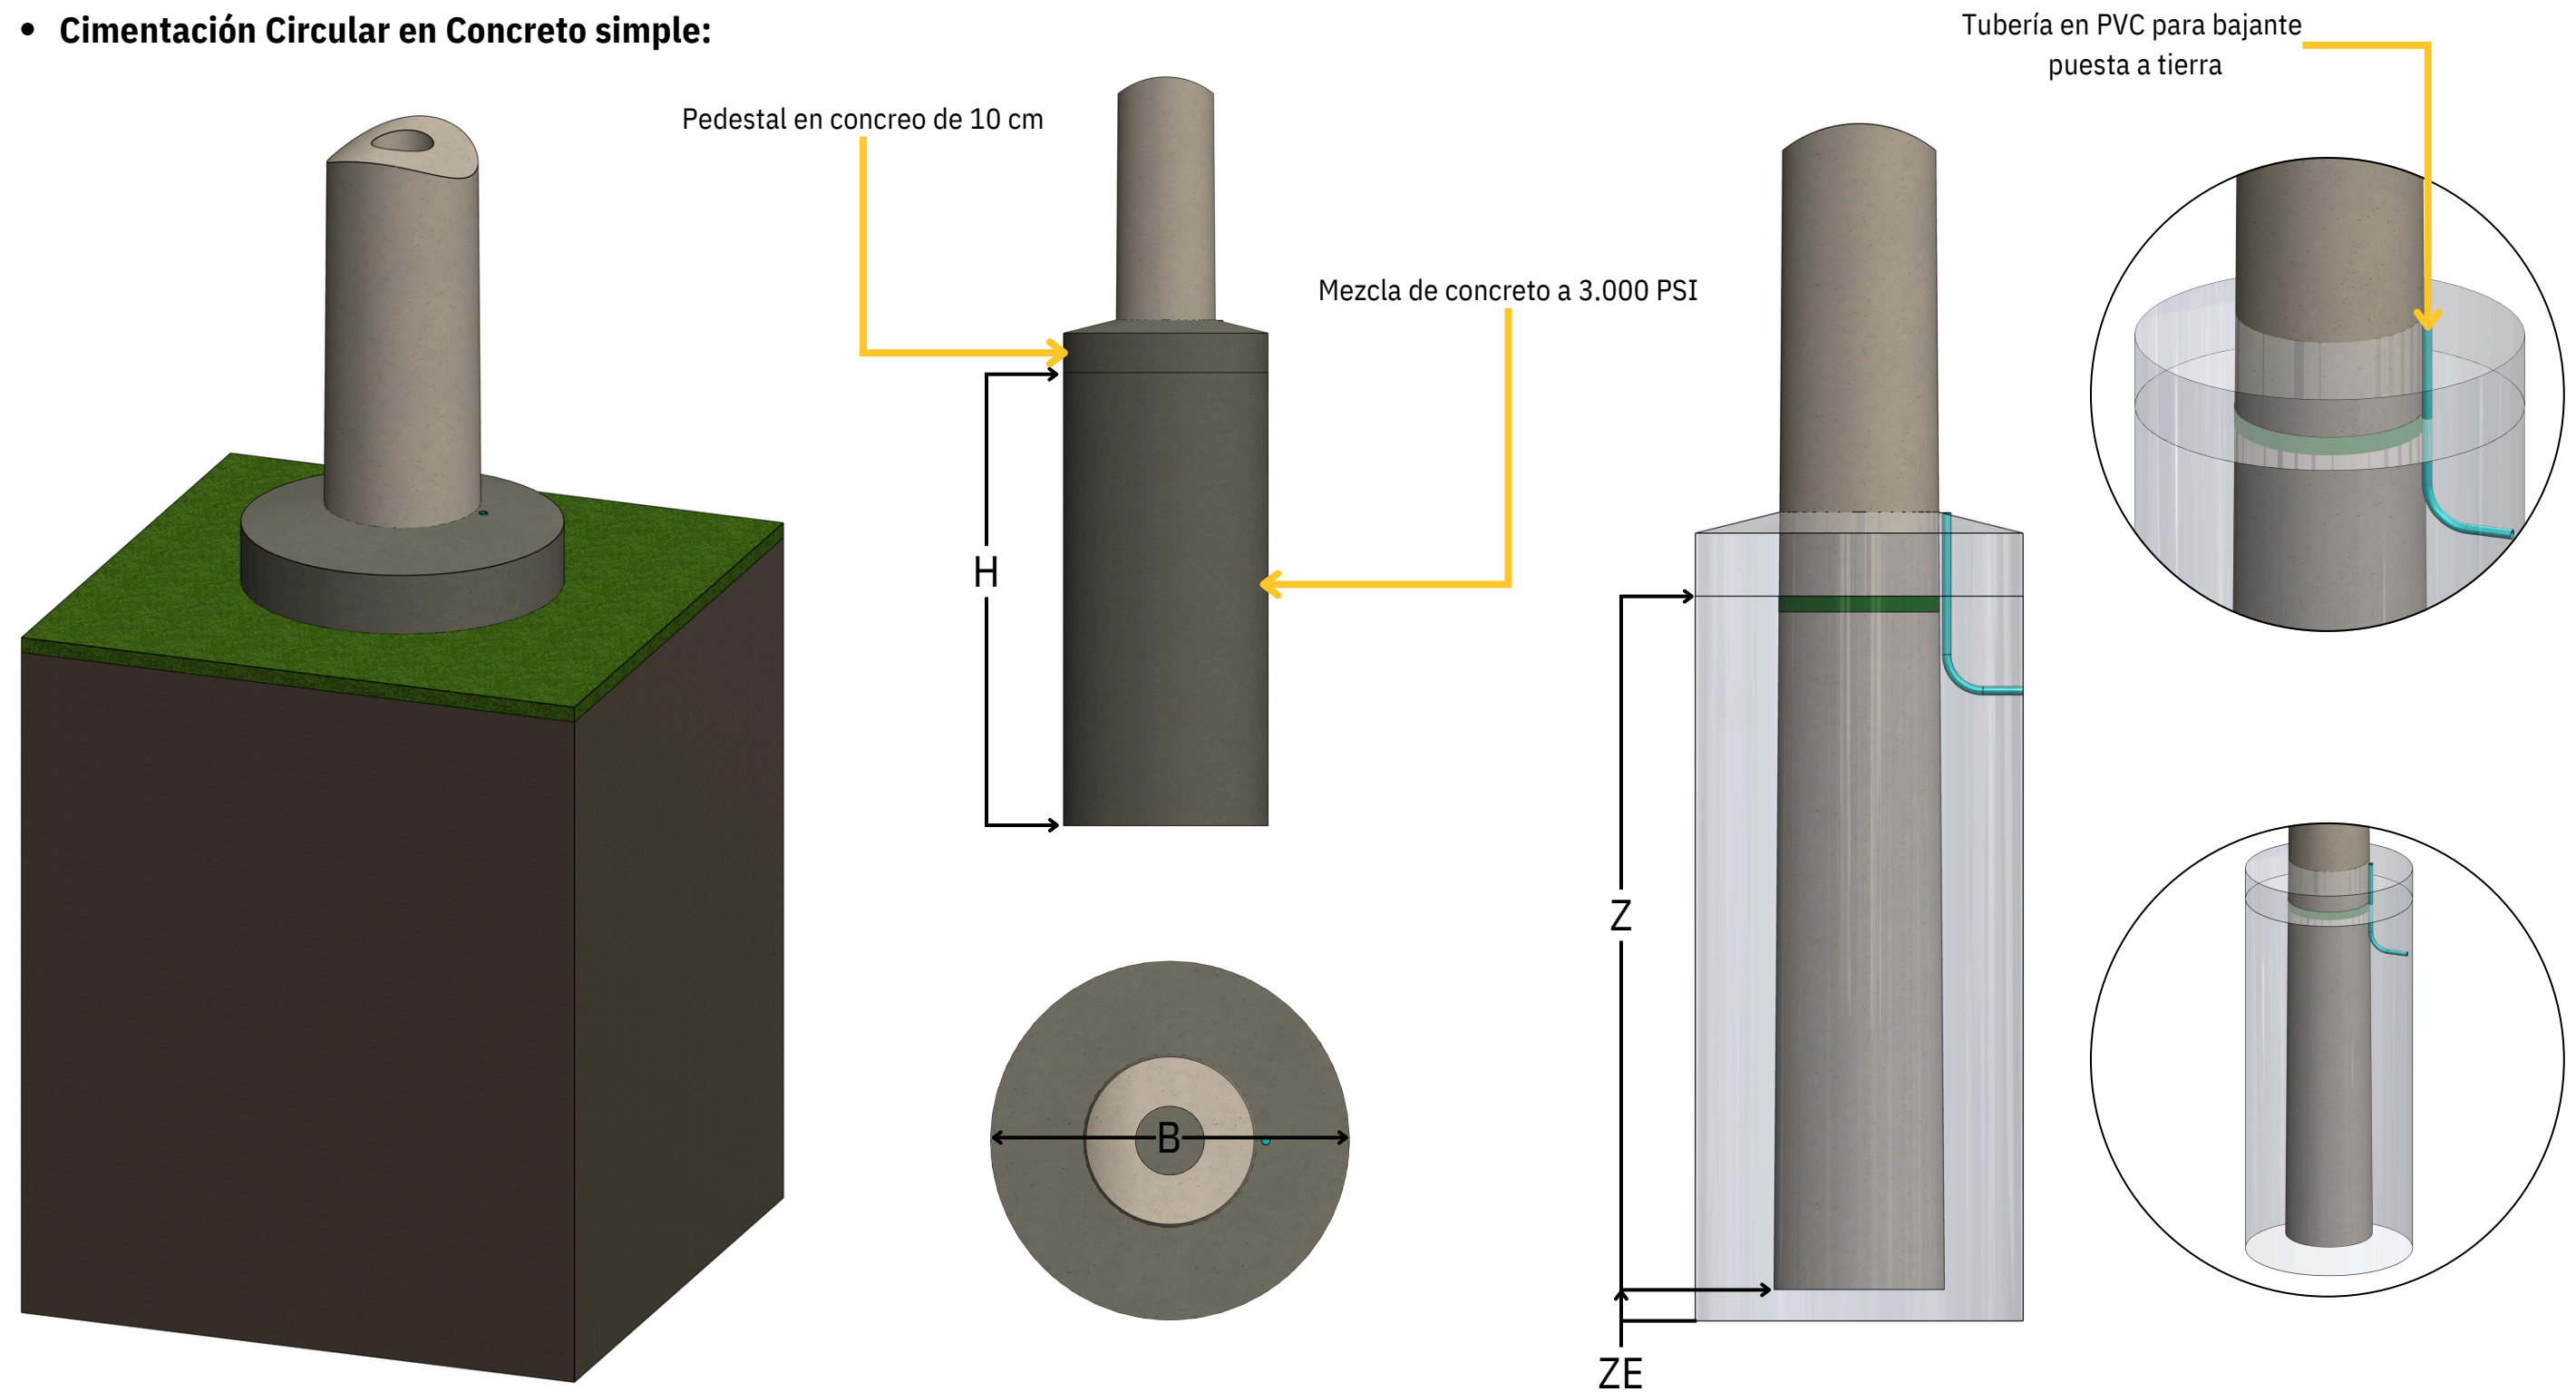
Geometría y Variables del Bloque de Cimentación Circular Concreto Simple
